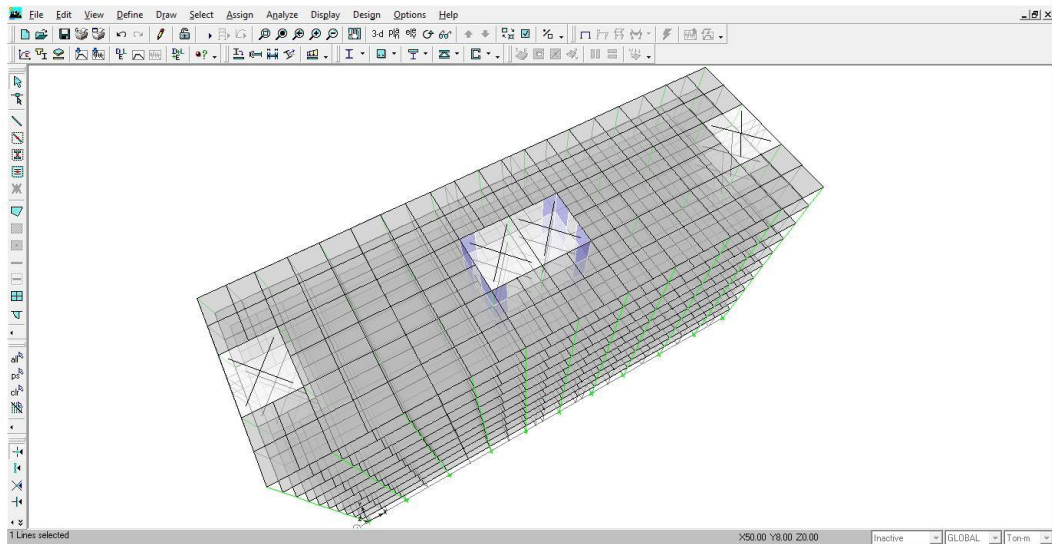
Denah Tampak Samping Arah x Struktur *Shearwall* Model 2
